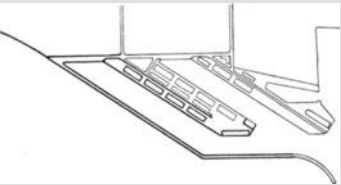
Trelleborg, preisgekrönter Entwurf für den Hafenumbau. Offener Küstenhafen mit Molen. Keine Gezeiten. Hauptwindrichtung: Süden. Maßstab 1:25 000.
